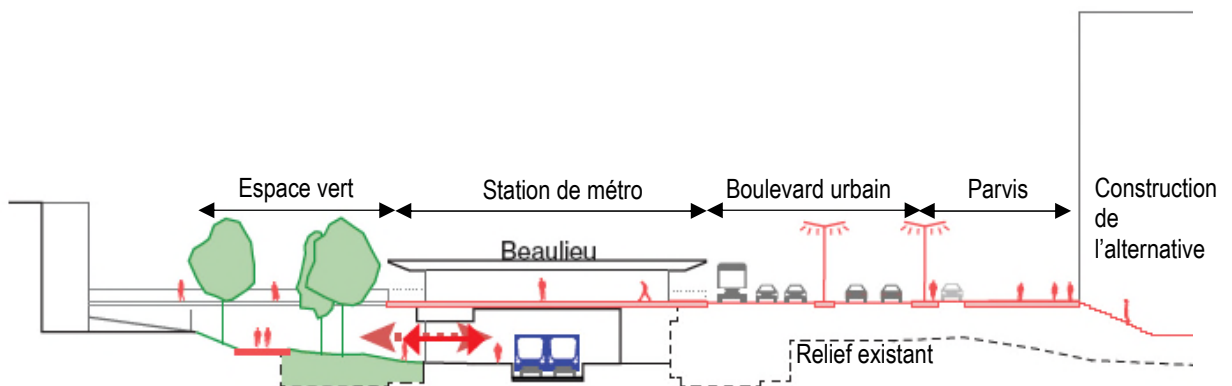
Profil de la place Beaulieu (ARIES sur fond ORG², 2018)
